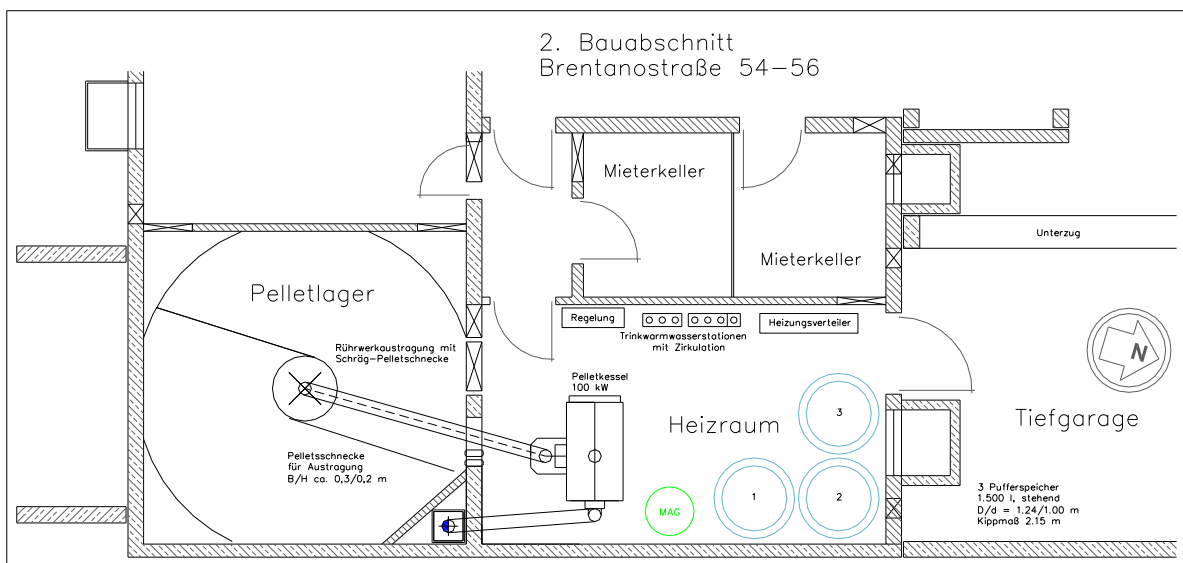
Ausschnitt Grundriss Kellergeschoss Brentanostraße 54, Kassel [Buchin, 2005]
